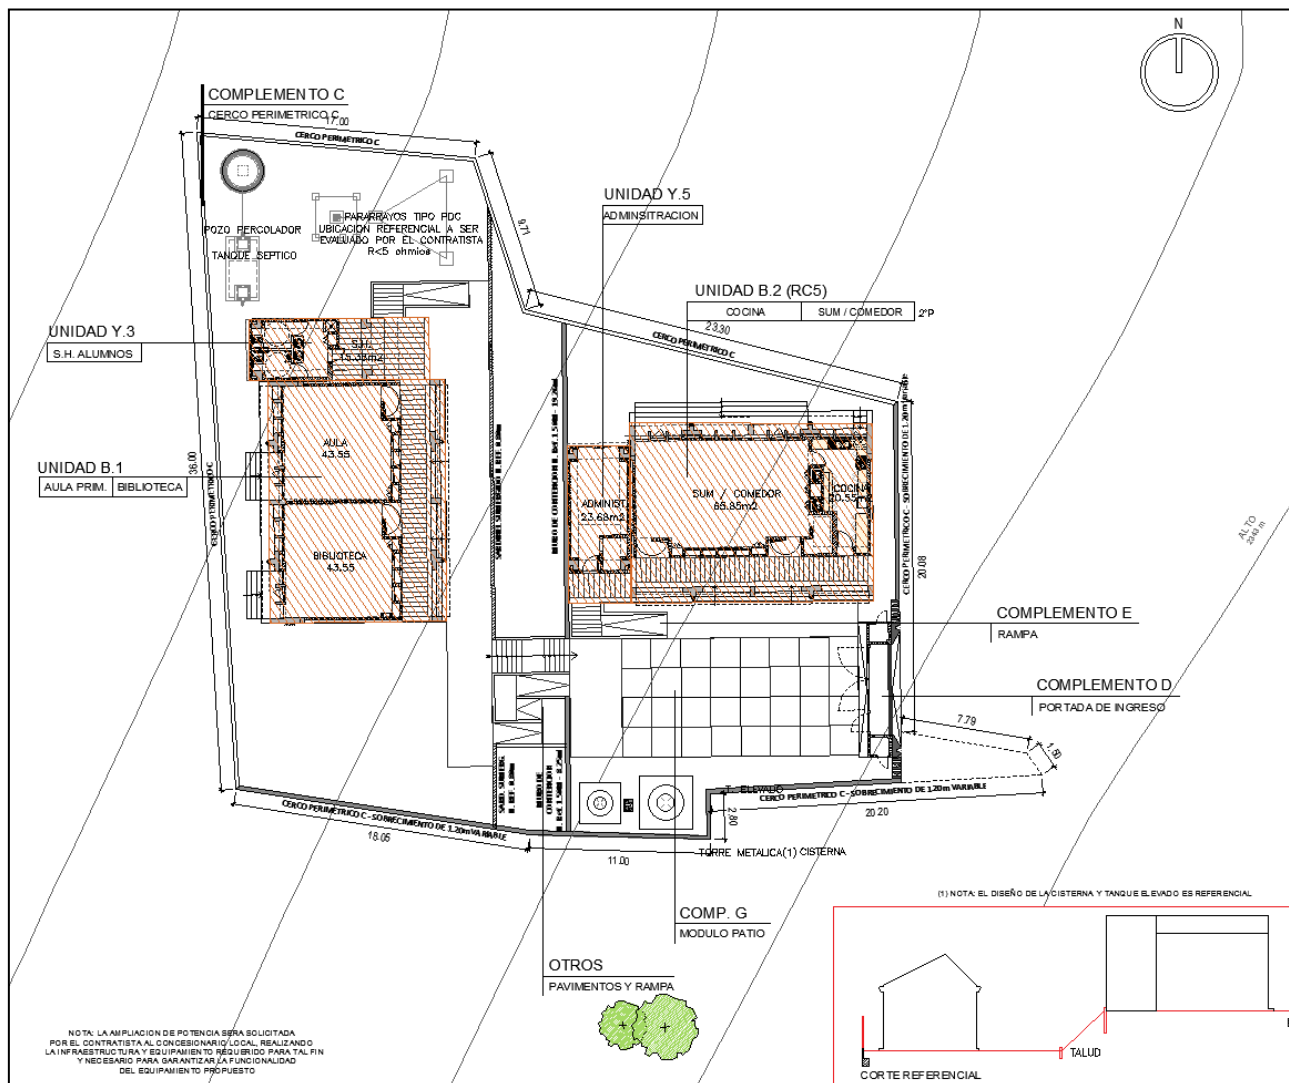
IE 86057 – CL 016001 – Planteamiento de Cabida desarrollado por el equipo UGRD. Fuente: Planteamiento UGRD 2022– Elaboración propia.
